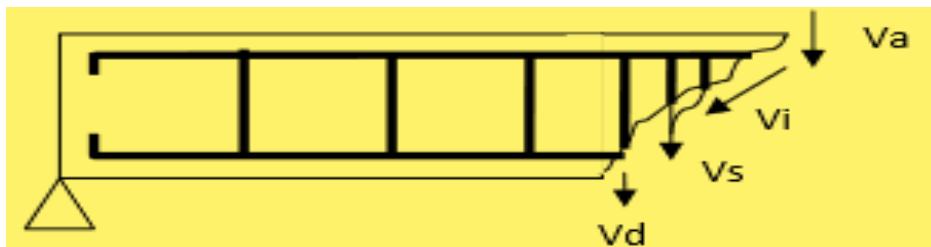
Comportamiento de Corte en una Viga en Concreto Reforzado. Fuente Rafael Contreras.
